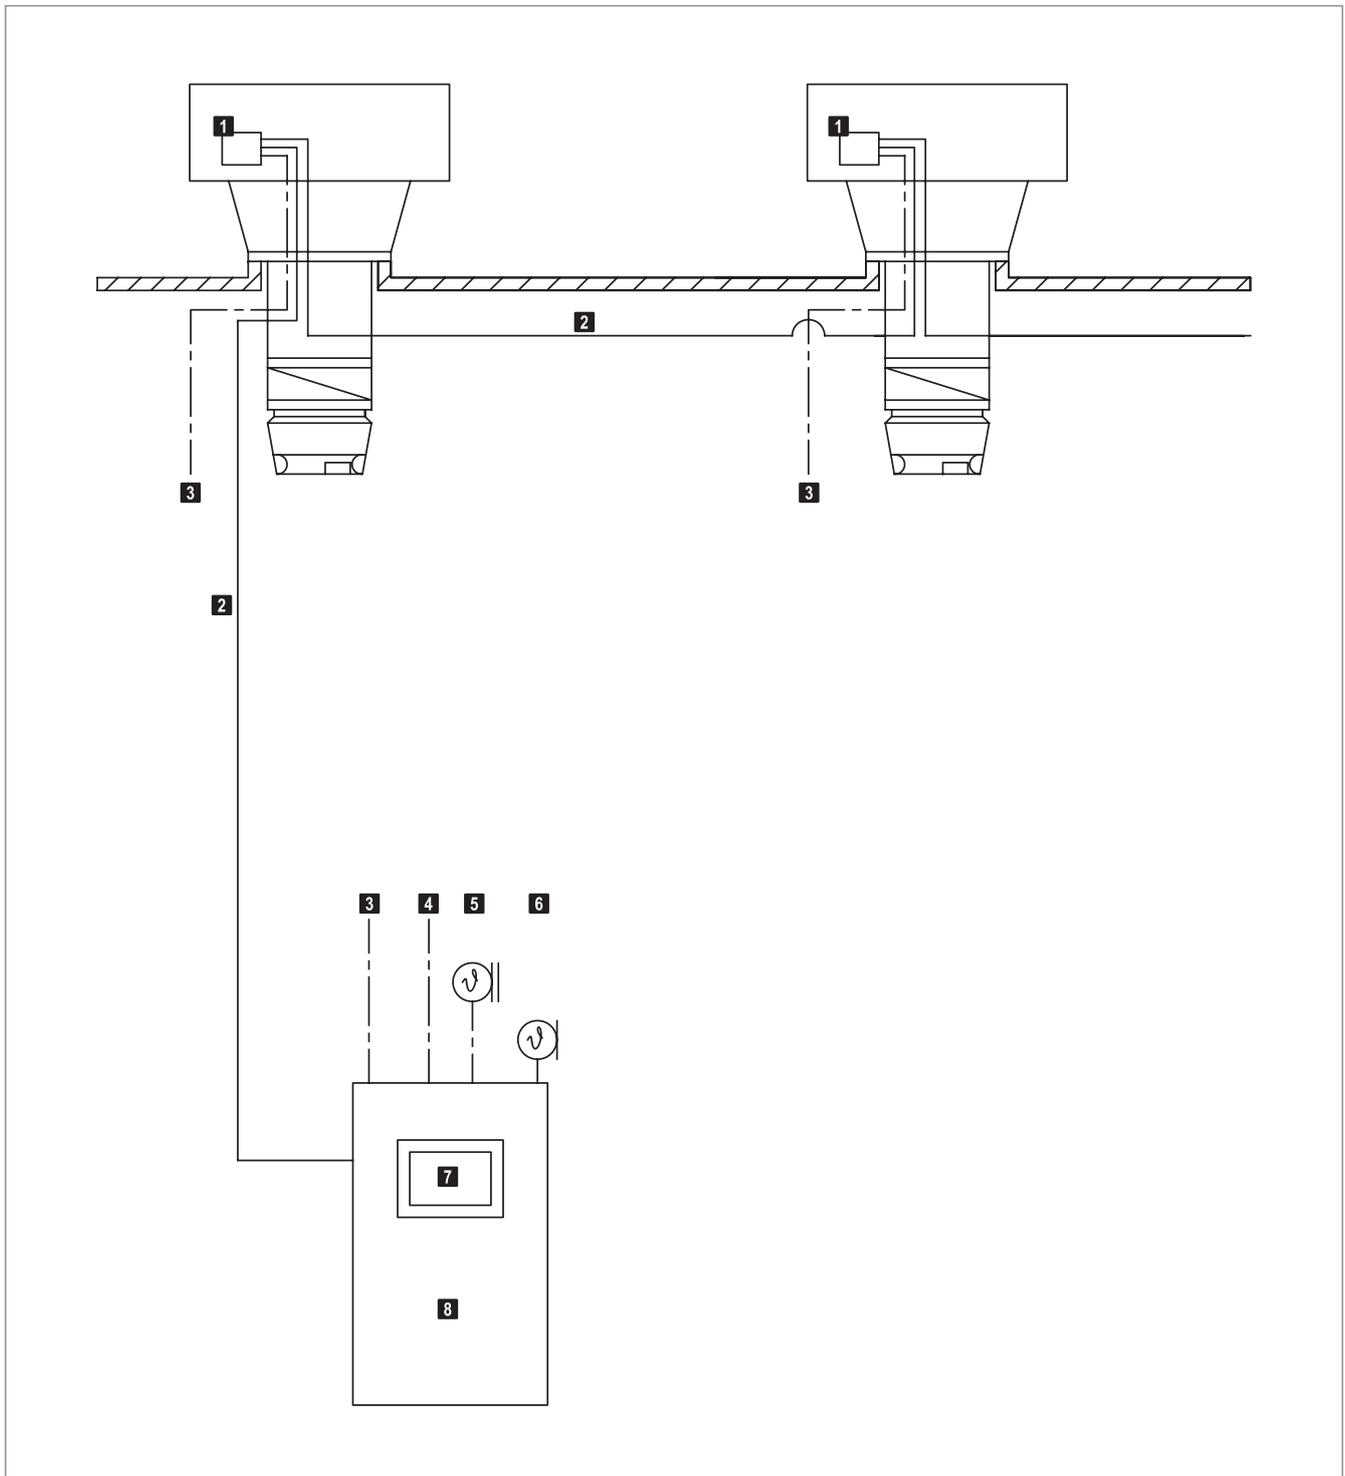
Les appareils RoofVent® sont installés depuis la toiture.
